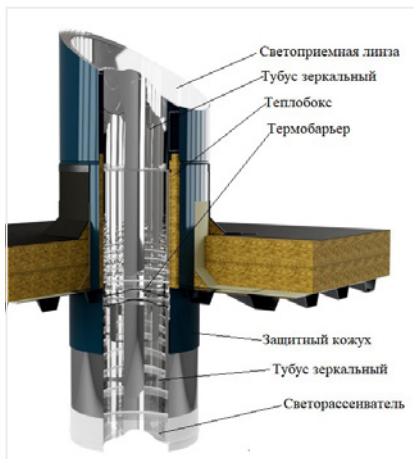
Устройство световода Энергоэффективные строительные конструкции
